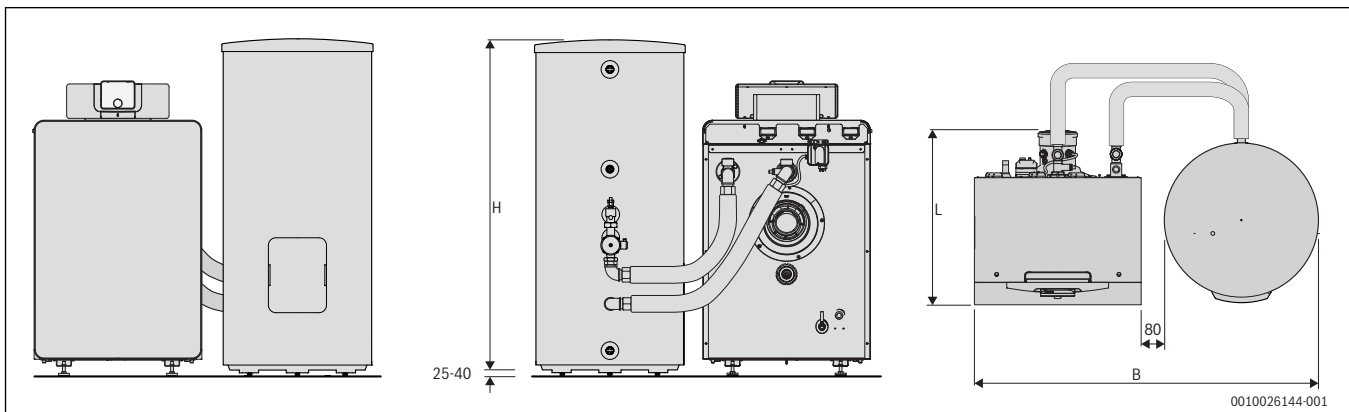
Abmessungen und Anschlüsse GC8000iF mit und SU (Maße in mm)
